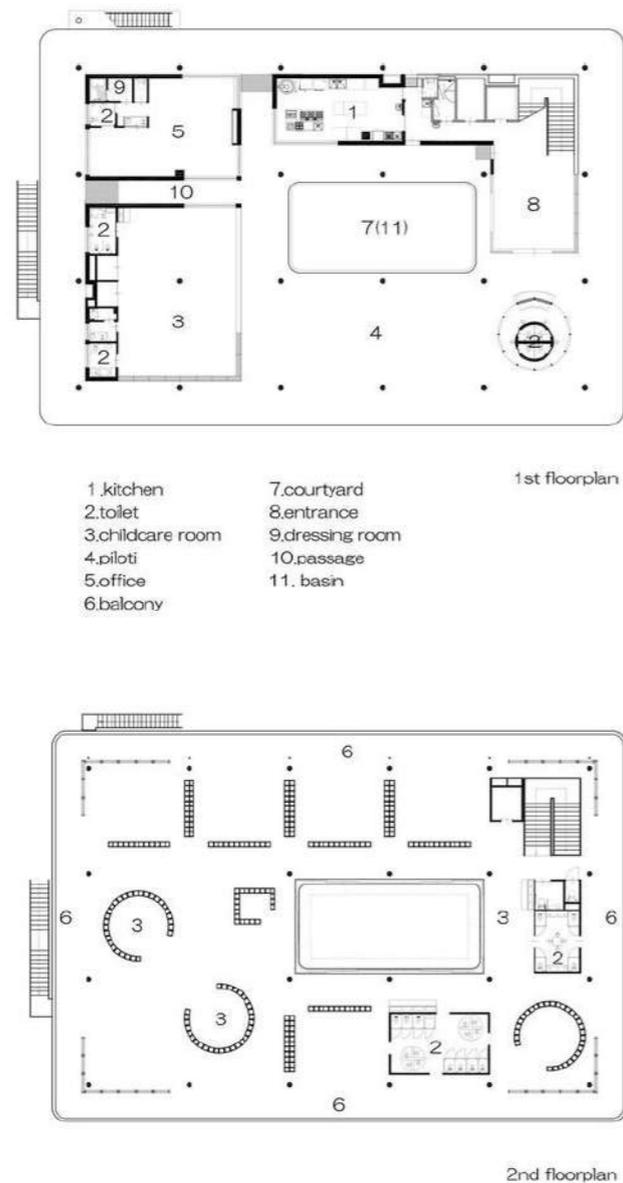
Planta baja y planta uno. Fuente: <https://e-ensha.com/en-d1-kindergarten-and-nursery/>
